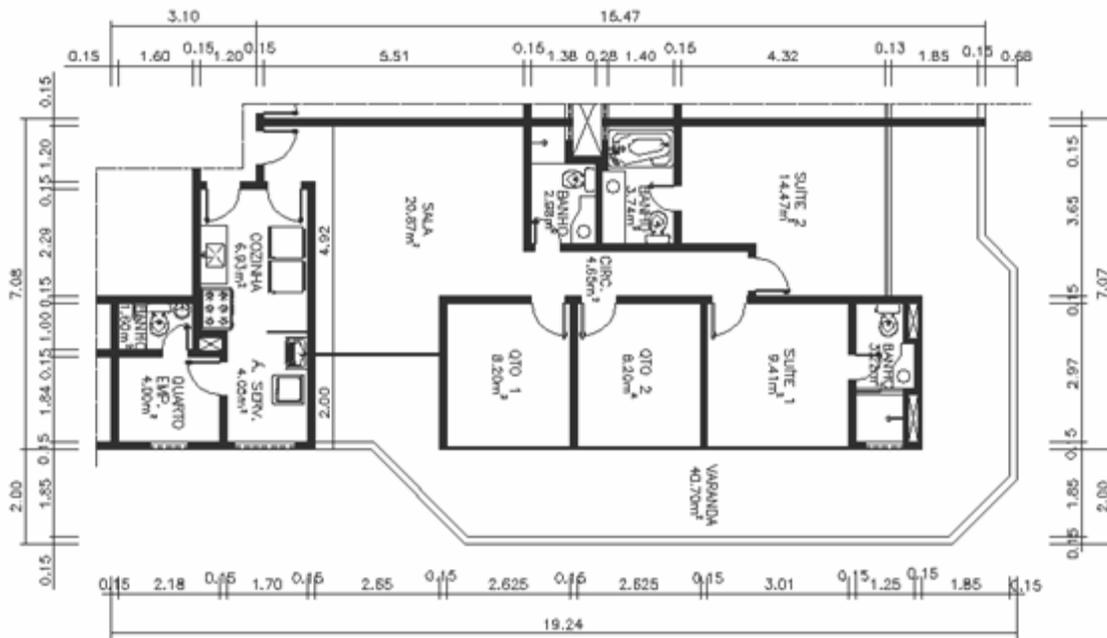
SQSW 305, Bloco G – Setor Sudoeste – Planta Original
